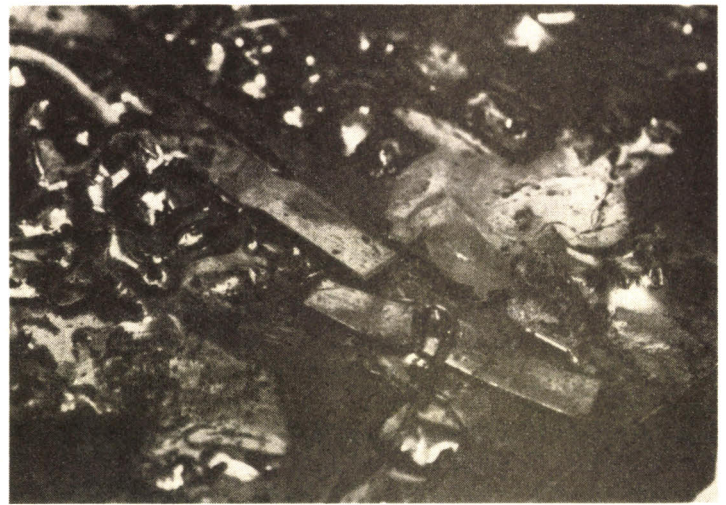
Photo M. – Détail de l'interrupteur encastré ici au milieu des soudures.
